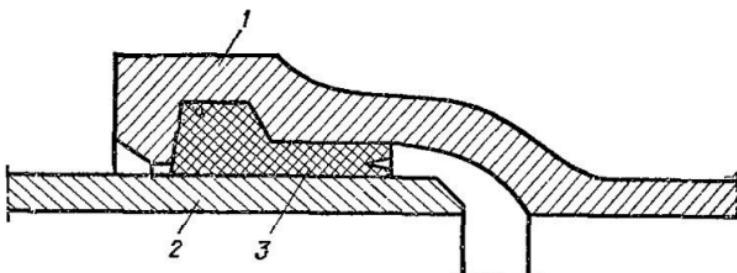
Конструкция стыкового соединения чугунных труб с резиновой самоуплотняющейся манжетой
